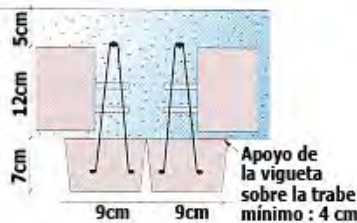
DETALLE DE APOYO DE VIGUETAS SOBRE TRABES PAREADAS
